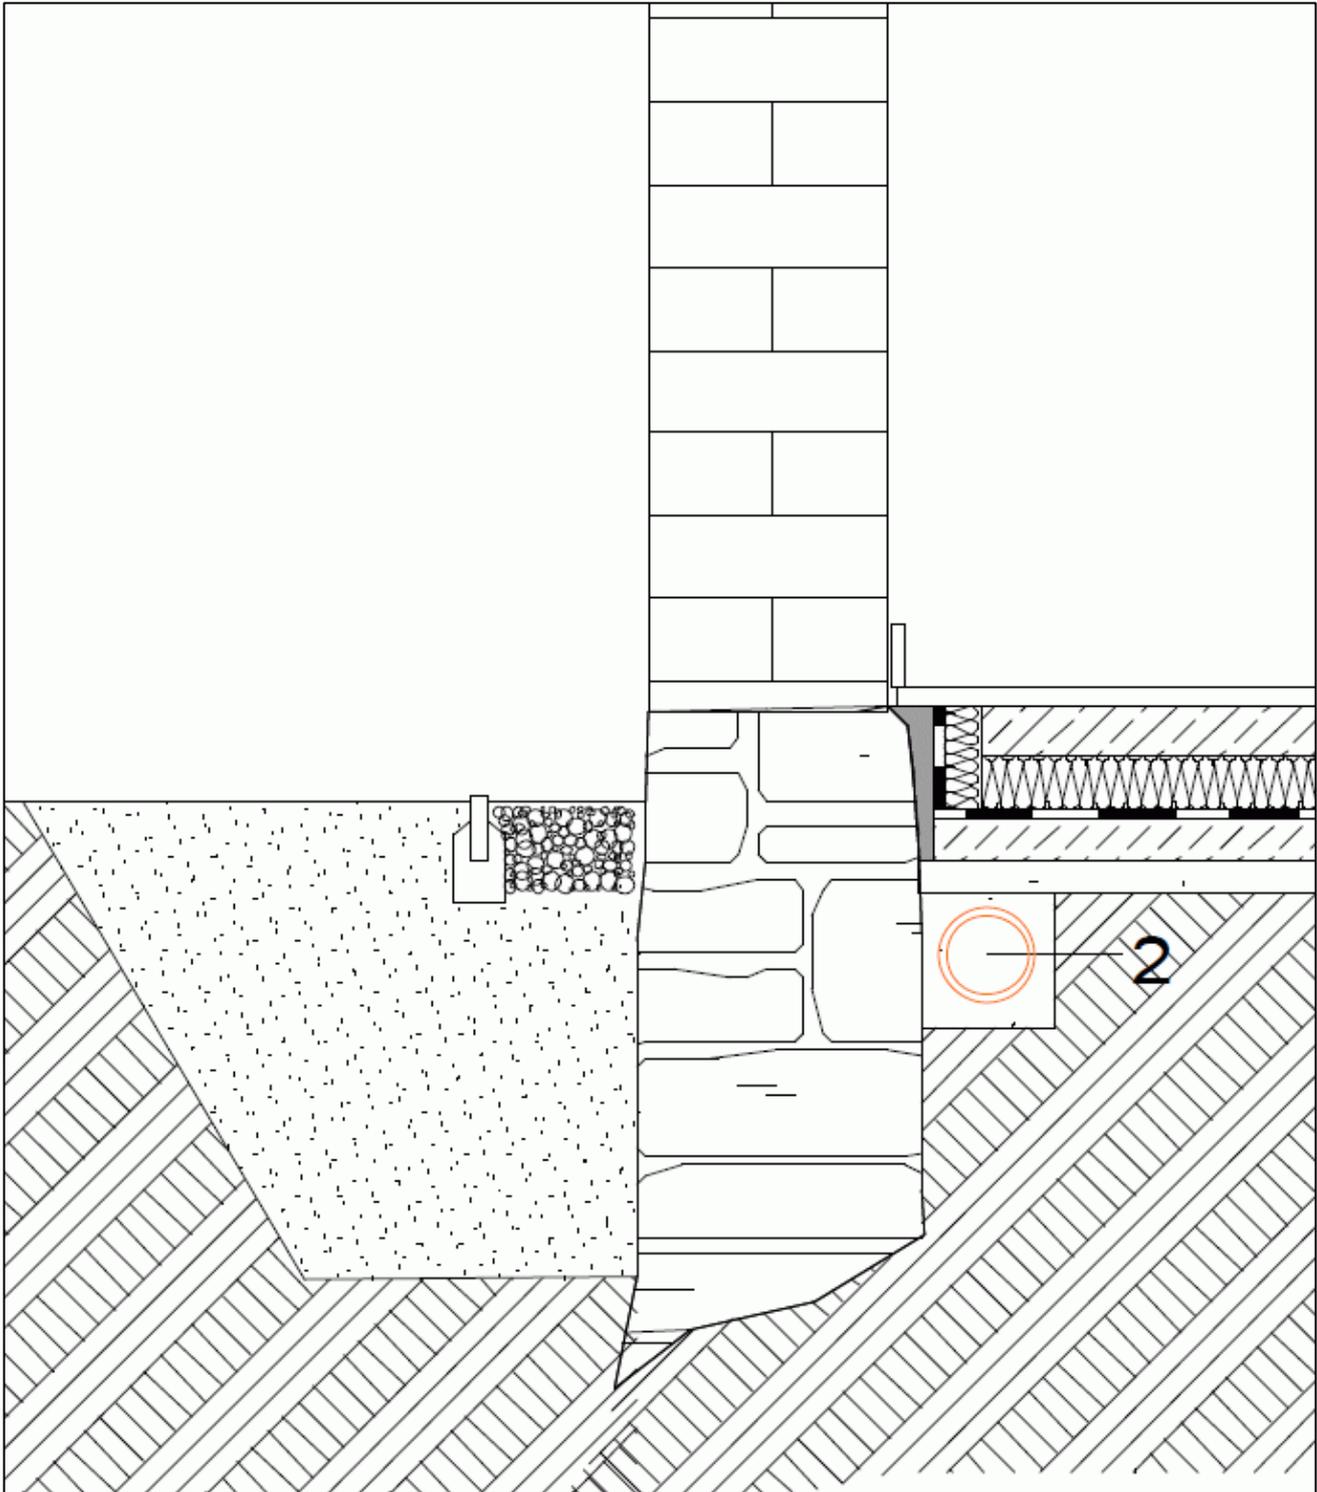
Detail Wandanschluss, Radondrainage Variante 1
